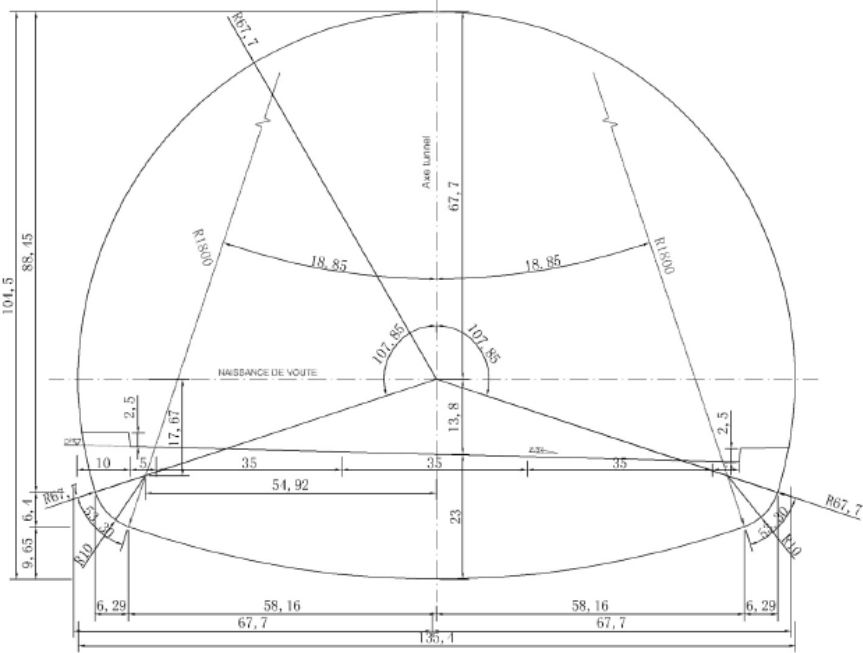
profil en travers de l'intrados du tunnel [3]
